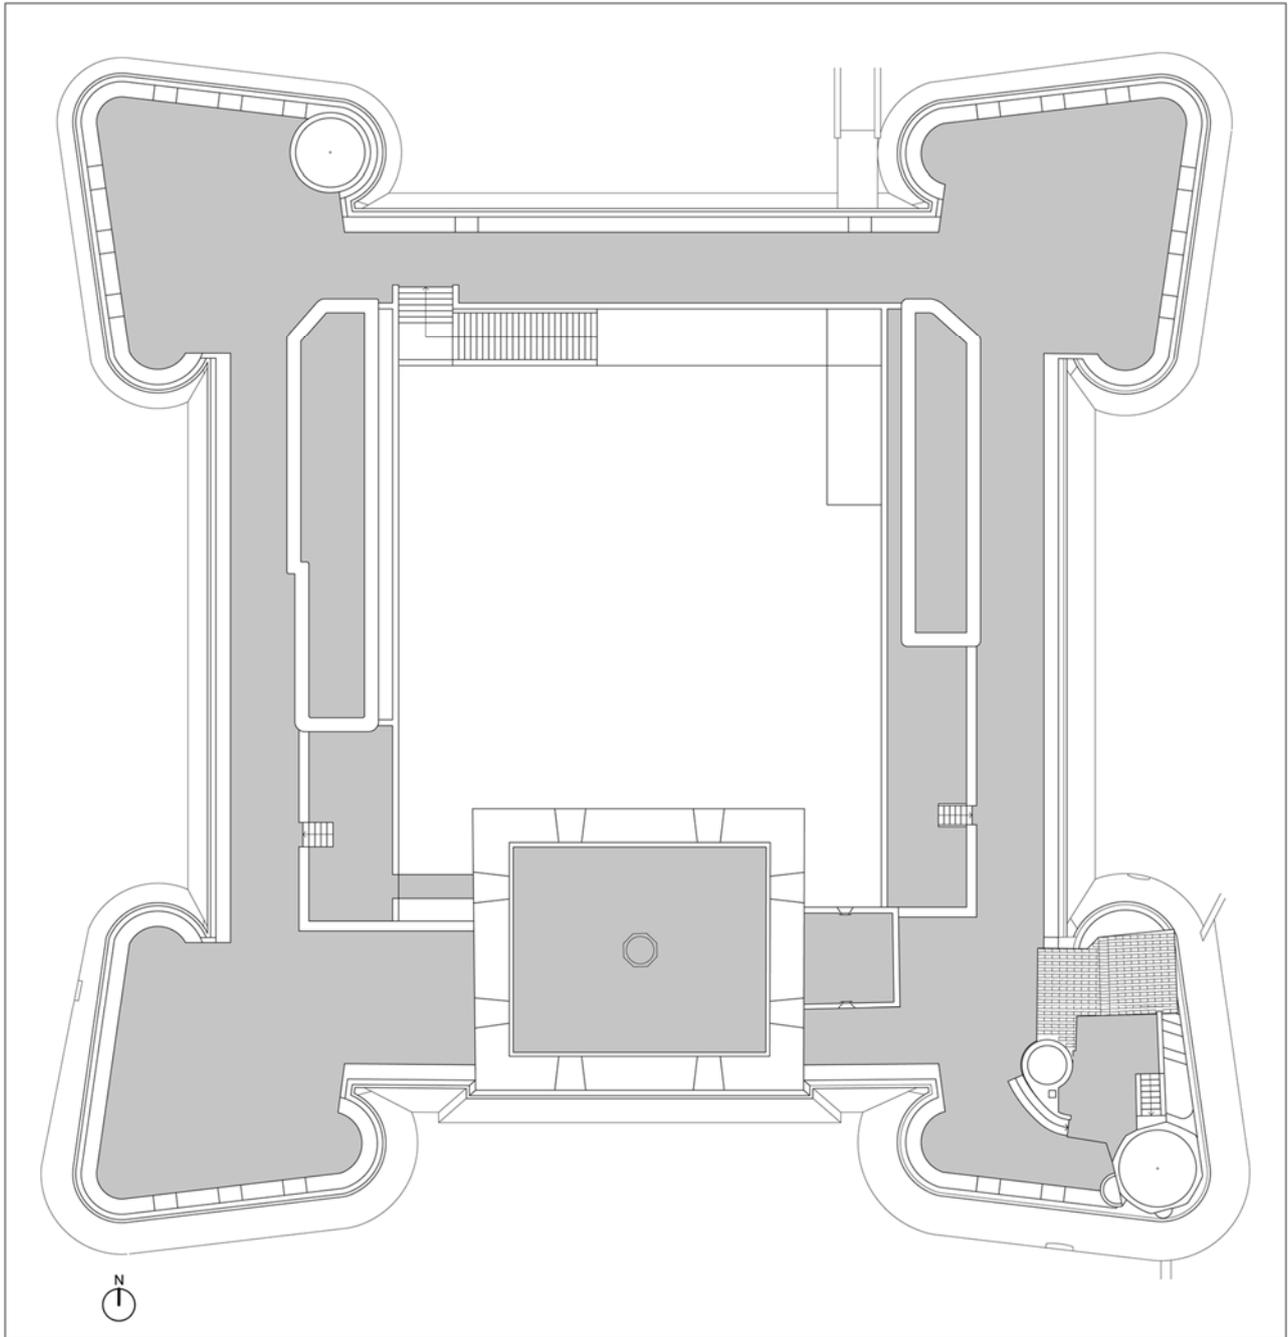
Pianta al livello della marciaronda: sulla destra la torretta di guardia e il locale accessorio.
